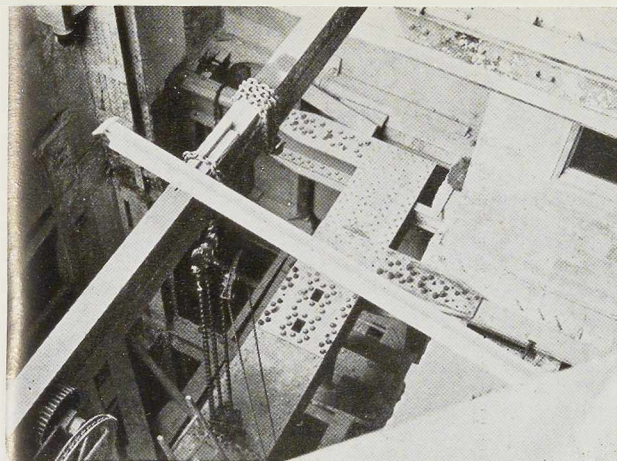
à 590. 3 étapes du montage des poutres travaillant en torsion.
